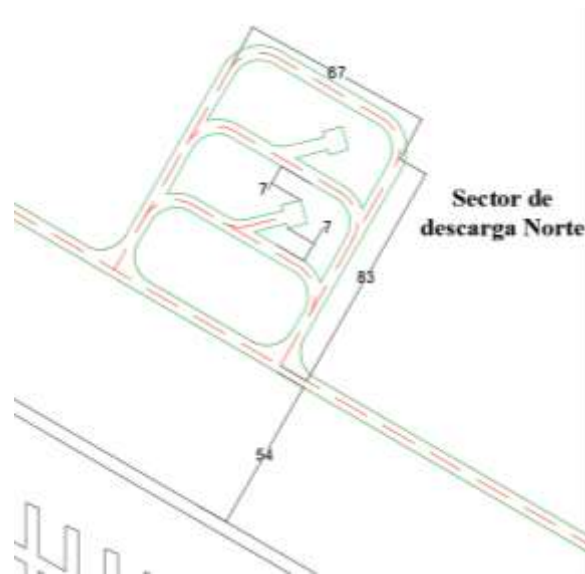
Sector norte de descarga de camiones de bajo perfil
